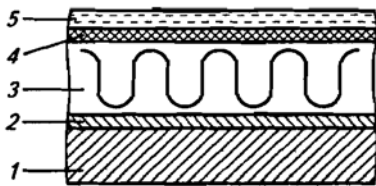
Пристрій покрівельного покриття із шаром теплоізоляційних плит «Rockwool» по залізобетонній підставі [1]: 1 - несуча залізобетонна плита; 2 - прокладка поверхні гарячим бітумом, що виконує роль пароізоляції; 3 - теплоізоляційні плити «Rockwool»; 4 - шар гідроізоляційного клеючого складу; 5 - гідроізоляційний килим з рулонних направляючих матеріалів
